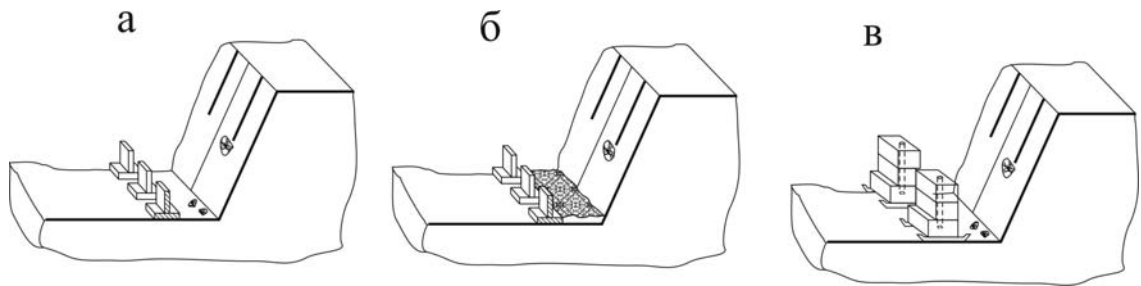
Конструкції протиобвальних уловлювальних, пересувних бетонних споруд: а – бетонні блоки-уловлювачі; б – бетонні уловлювачі з м'якою «подушкою»; в – пересувні розбірні бетонні блоки.
